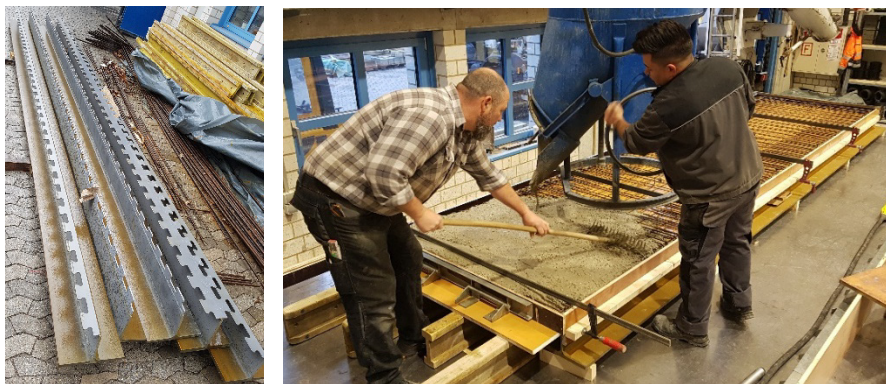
Stahlträger mit angeschweißten Verbunddübelleisten (links) und Betonage des Probekörpers VBT-1 mit Transportbeton (rechts)
